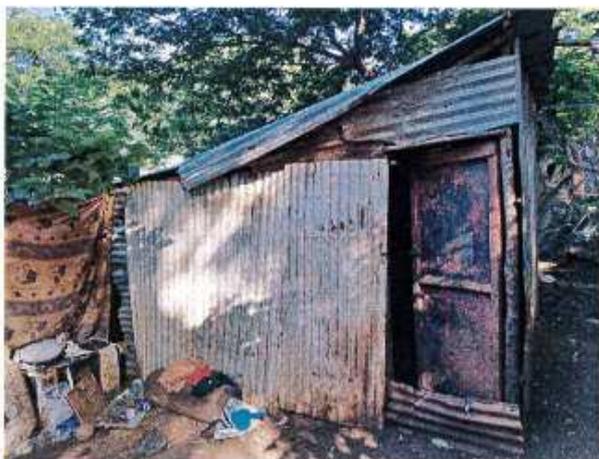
construction dépourvue de fondations, tôle clouée sur structure en bois, manque d'éclairage naturel dans la pièce de vie
